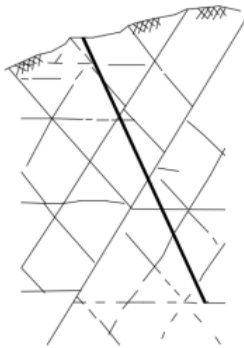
Perforación intersectando varias discontinuidades. Adaptado de "Construction and design of cement grouting" de Houlsby, A.C. (1990).
